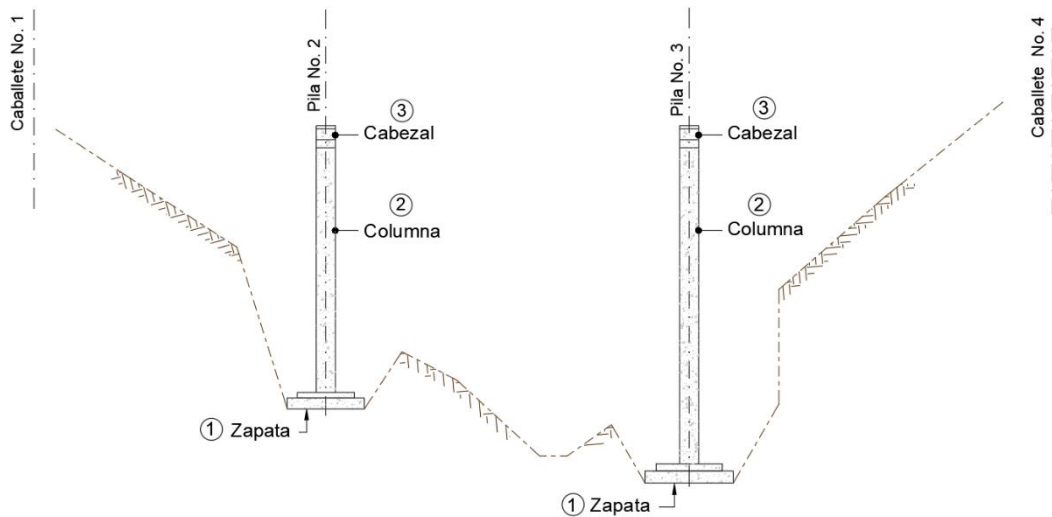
Construcción de las pilas centrales. Fuente: Elaboración propia
